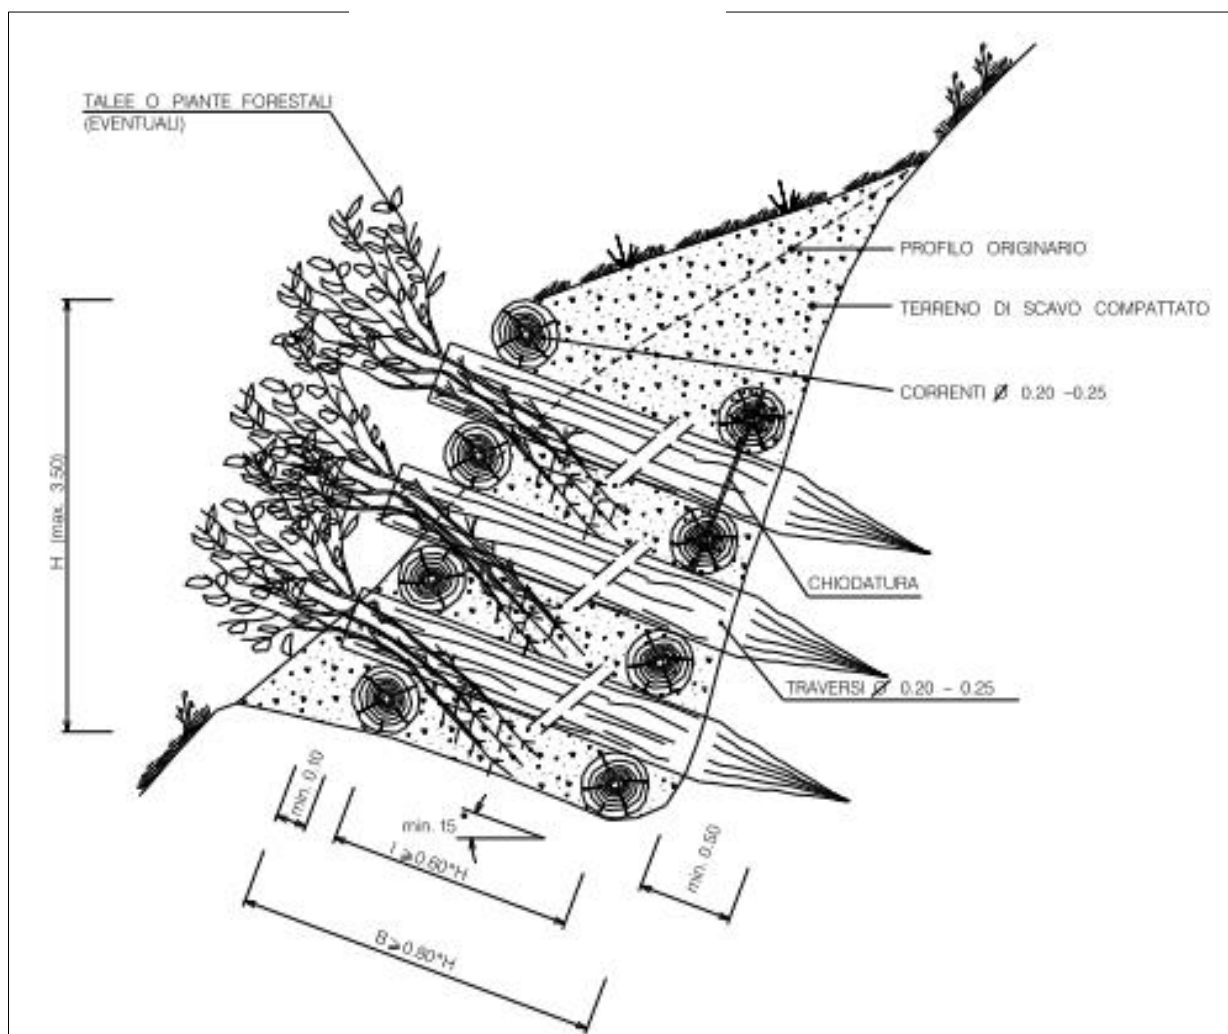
Muro cellulare in legname a parete doppia.
